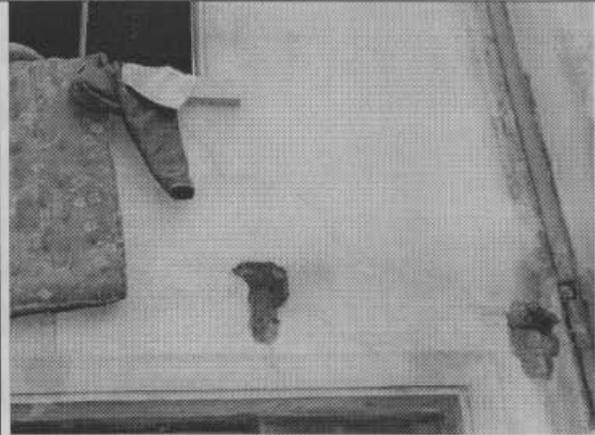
Muros de la fachada Interna de la vivienda con agrietamientos.
